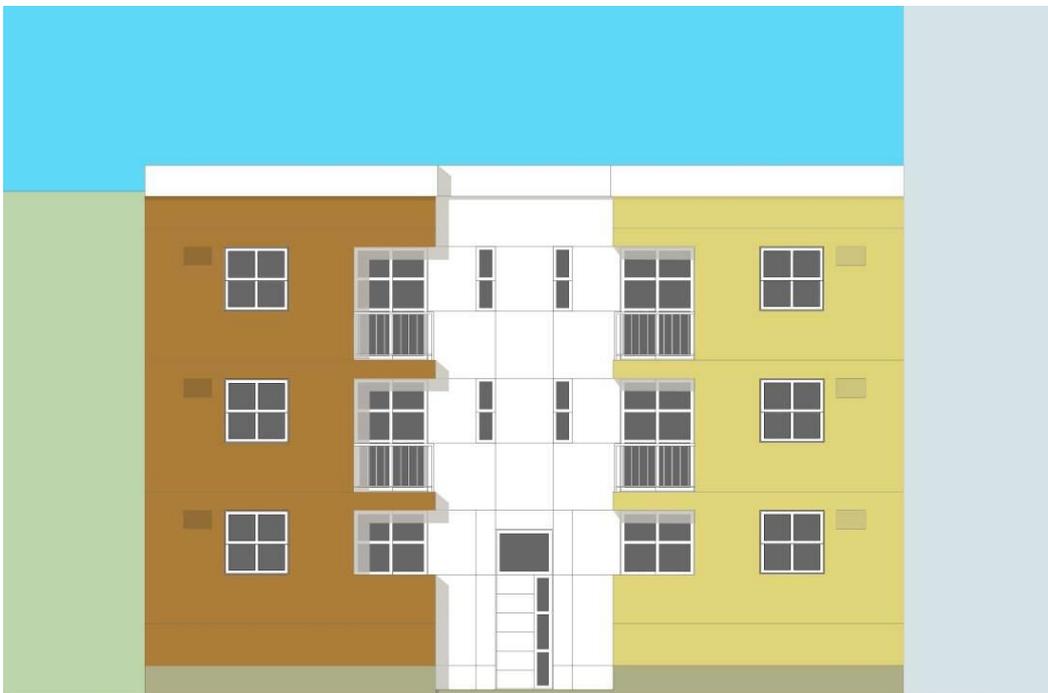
Fachada projetada para a Rua Sacadura Cabral 143
